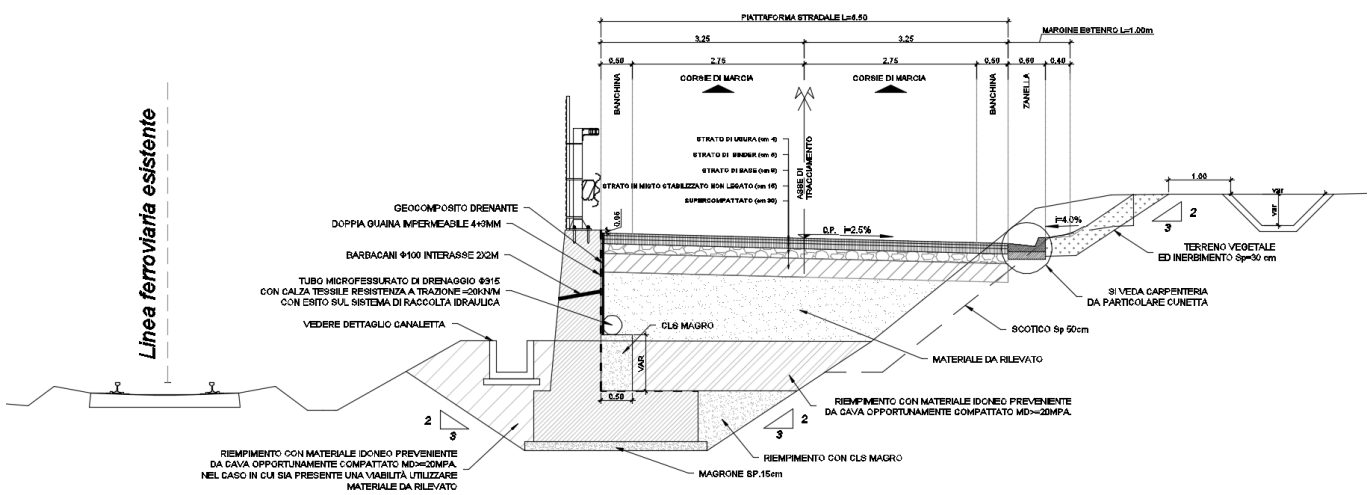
Asse 5 – Sezione tipo in affiancamento alla ferrovia con trincea in DX
